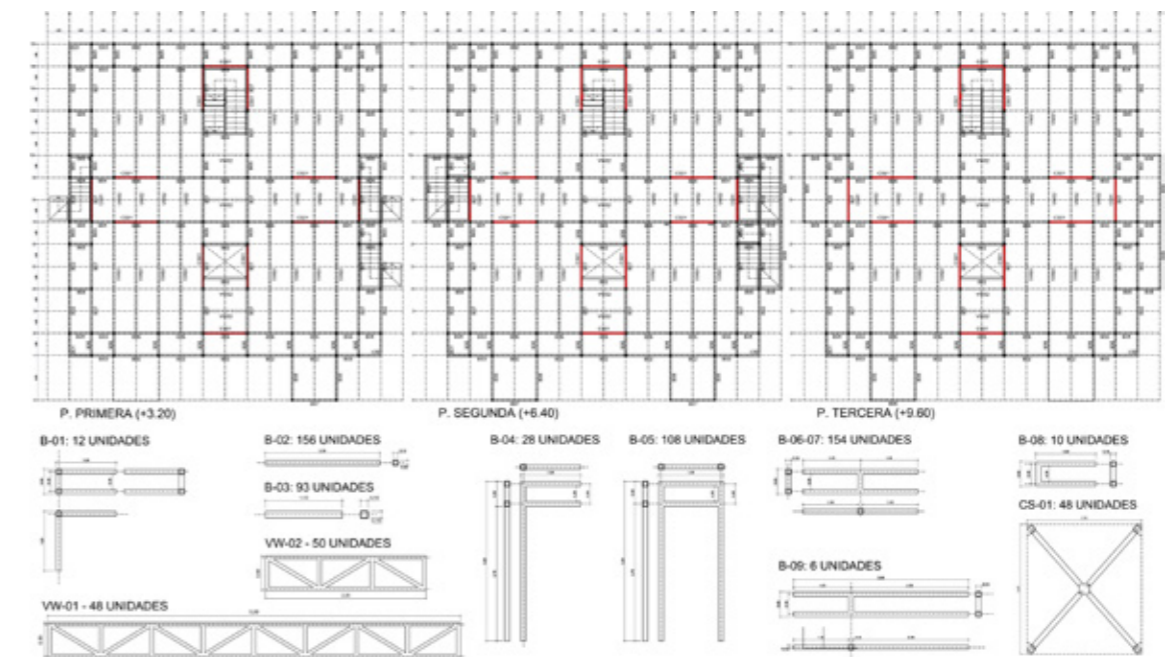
Plantas estructura. Piezas prefabricadas. Fuente: autores.
